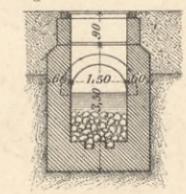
Abflusskammer des Filters zu St. Louis. M.1:100.
